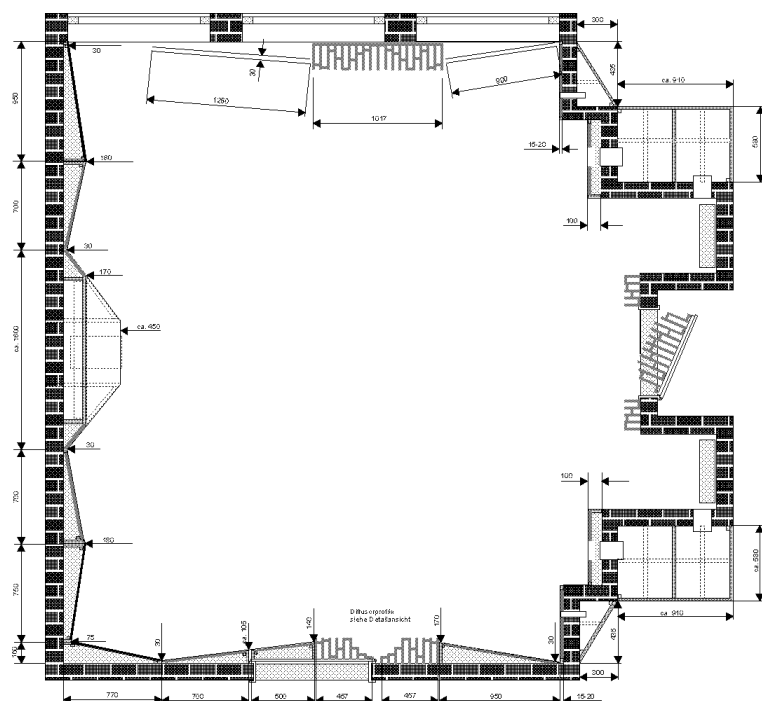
Grundrisschema des Mehrkanal-Abhörzimmers mit der optimierten geometrischen Form und der raumakustischen Oberflächengestaltung
